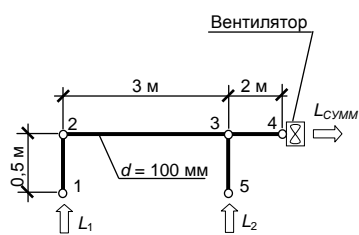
Расчетная схема системы вентиляции двух помещений
